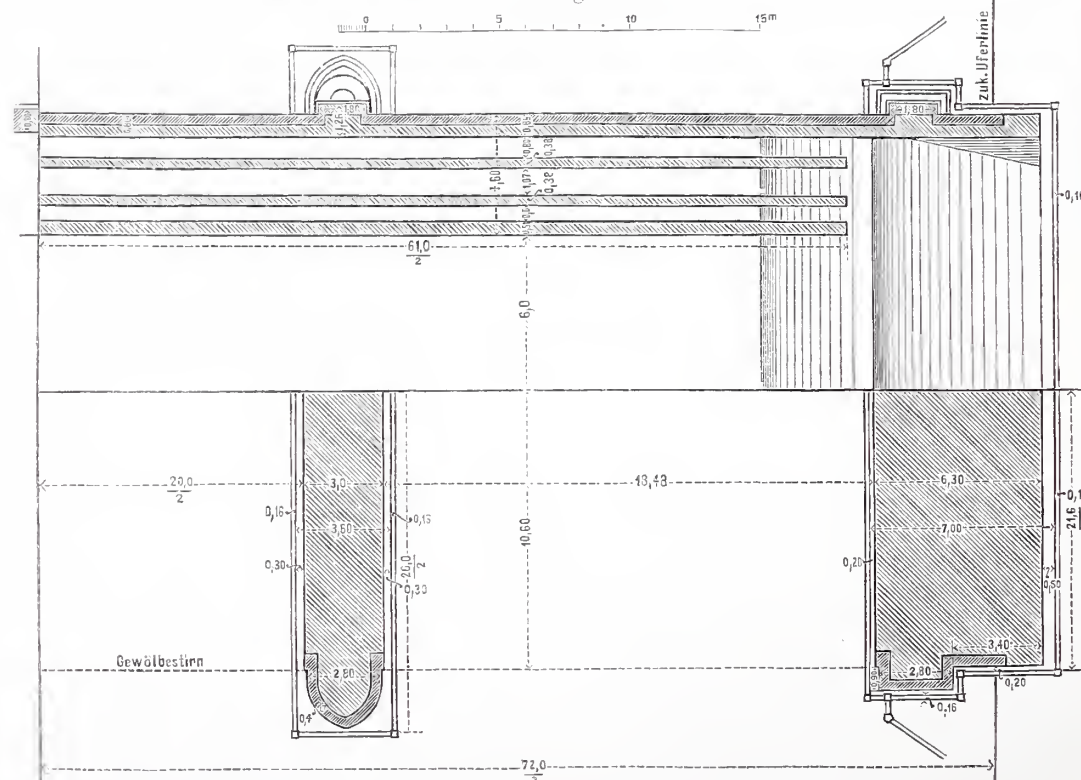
Grundriss in Höhe des Hauptgesimses und in Kämpferhöhe.
